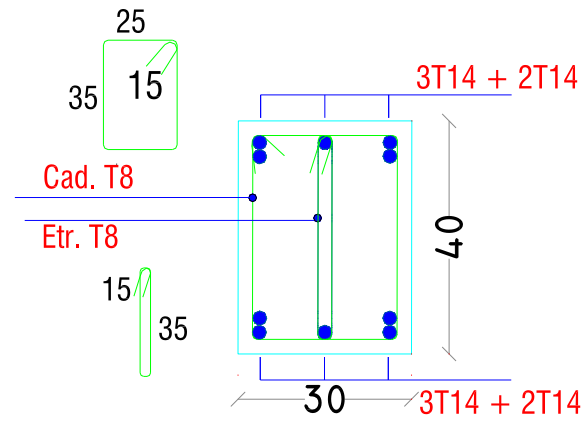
Ferraillage des poutres principales pour Etage 1,2 et 3.
